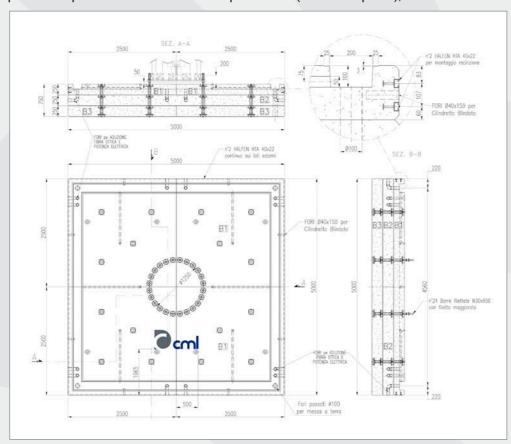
Pianta e sezione del FAST SITE® SYSTEM 24
